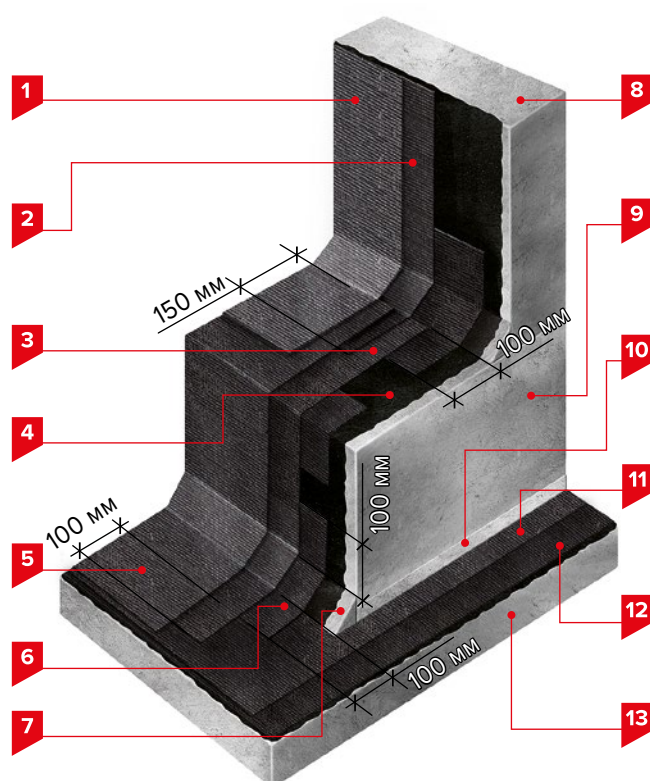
Техноэласт Фундамент. Зона подошвы фундамента:
